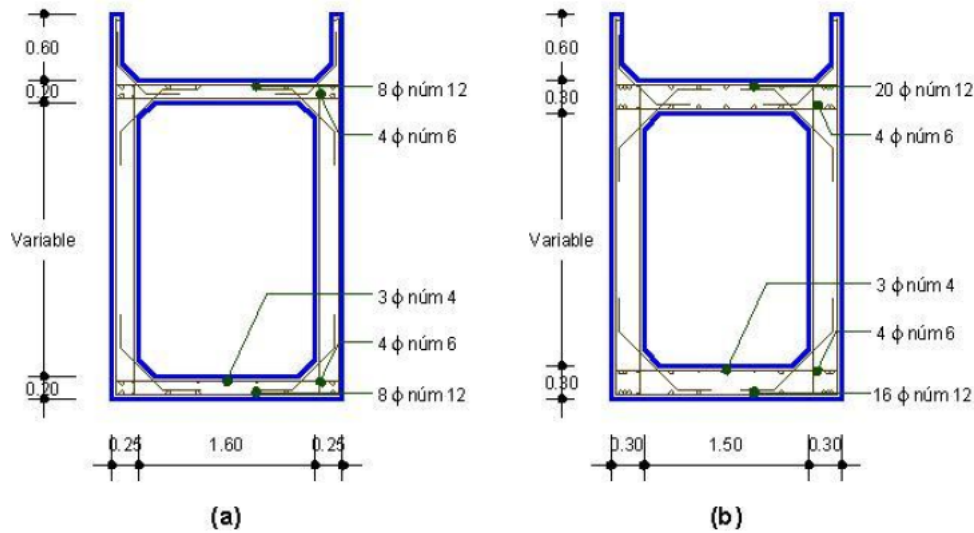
Sección y armado de las trabes de rigidez. (a) Trabe de rigidez superior. (b) Trabe de rigidez inferior.
